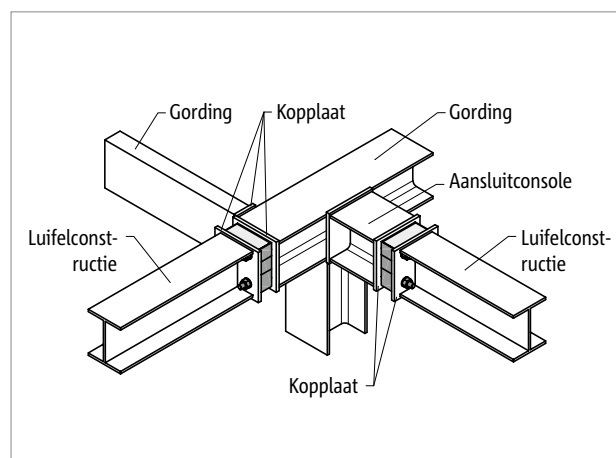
Schöck Isokorb® T type S-N en T type S-V: Vrij uitragende staalconstructie
